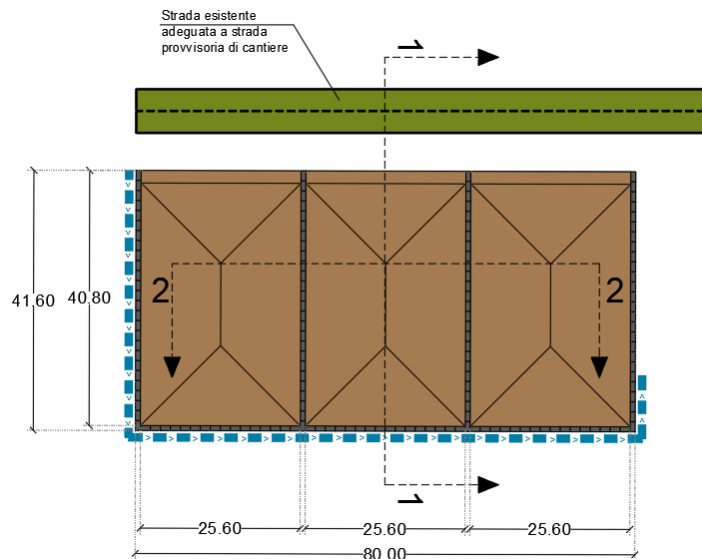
Planimetria depositi DI05 - DI06 - DI09
